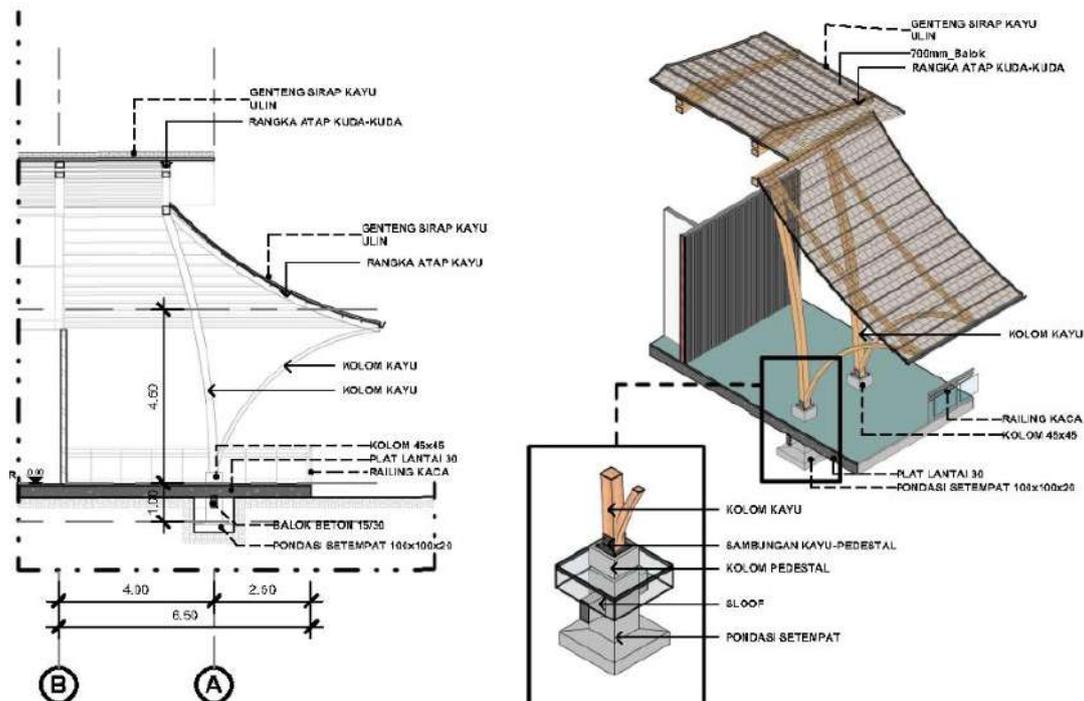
Tampak samping Gedung Fasilitas dan Pengelola
